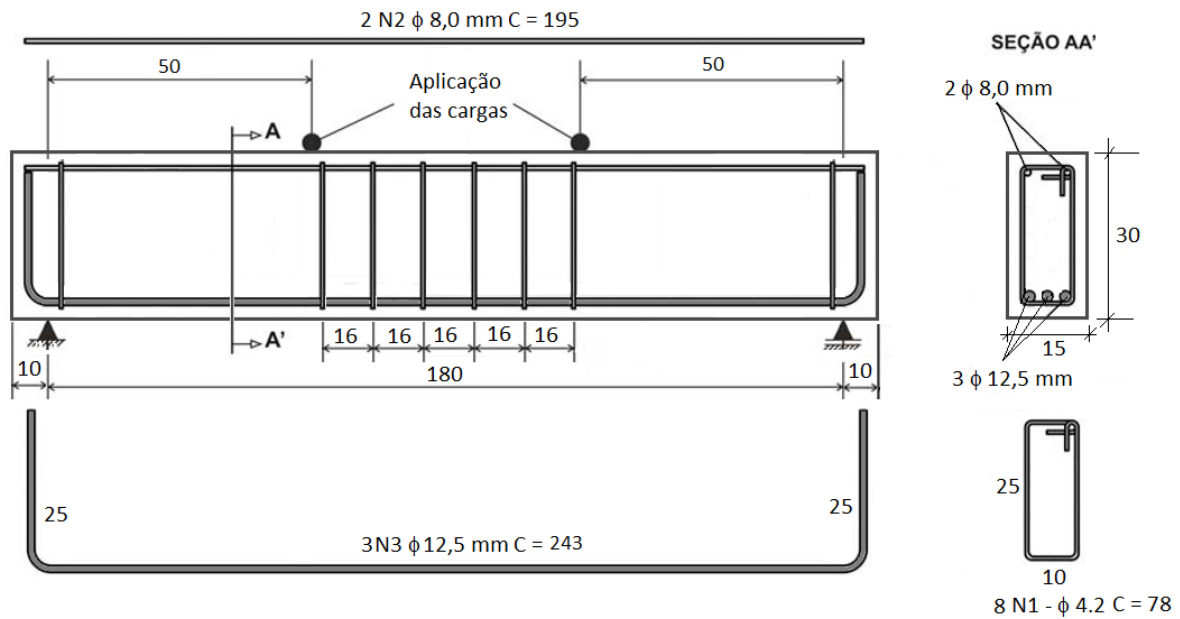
Esquema de detalhamento das armaduras das Vigas 6 para $a = 50,0$ cm, cotas em centímetros.
